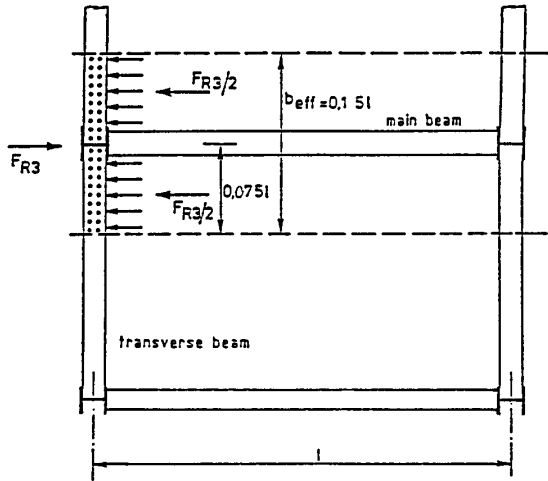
Transmission de la Force F_{R3} de la dalle par la poutre transversale.
